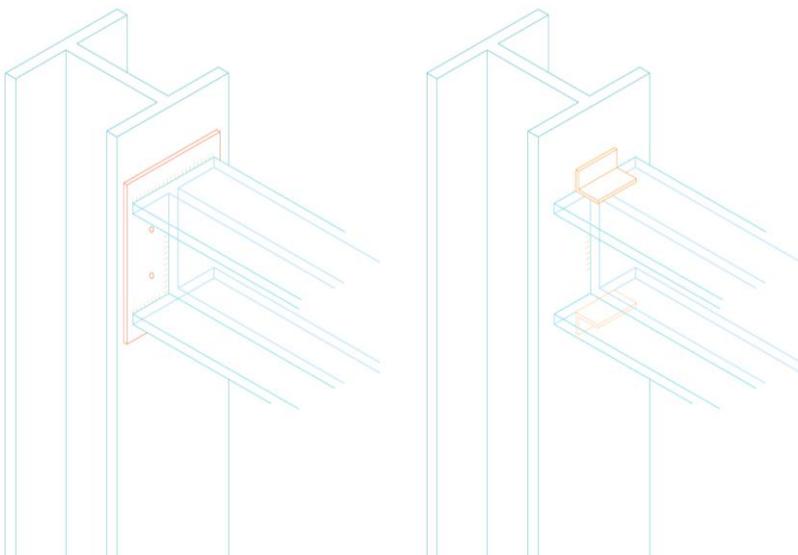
Ejemplos de las uniones entre viga y pilar (Dibujo original)
